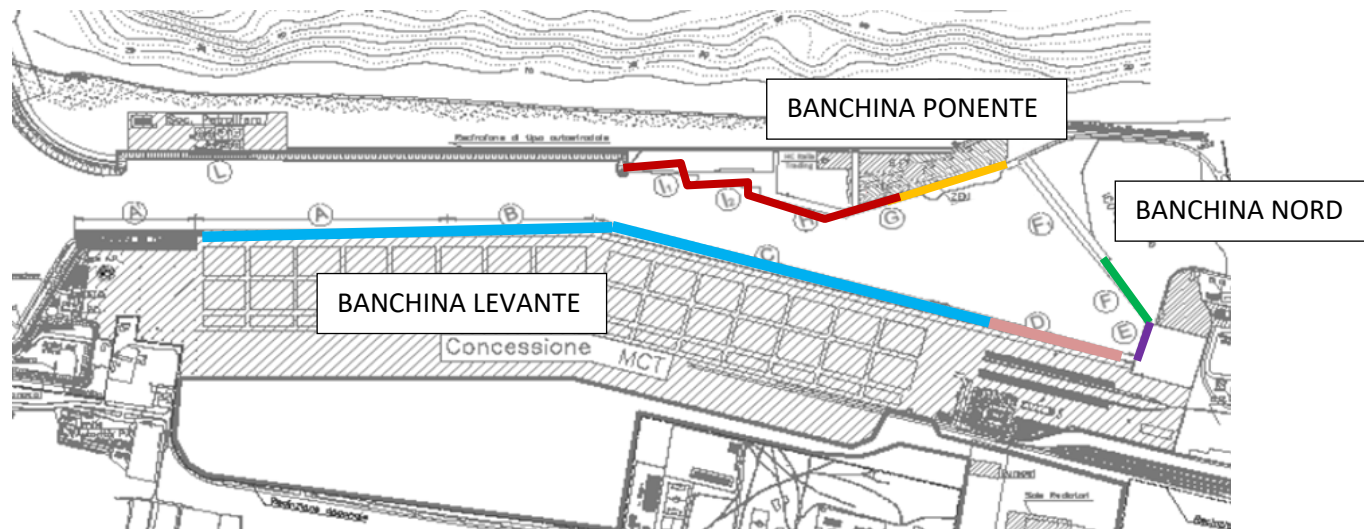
Planimetria portuale con indicazione tratti di intervento già autorizzati .in azzurro il tratto di banchina escluso dall’assoggettabilità a VIA nel 2006, in rosa il tratto di banchina escluso dall’assoggettabilità a VIA nel 2011, in
